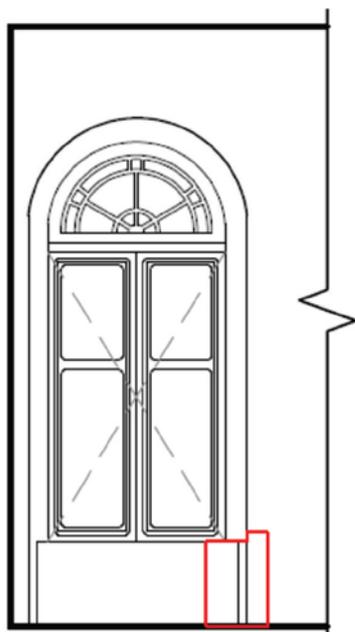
Elevação da prospecção arquitetônica 6 na parede
